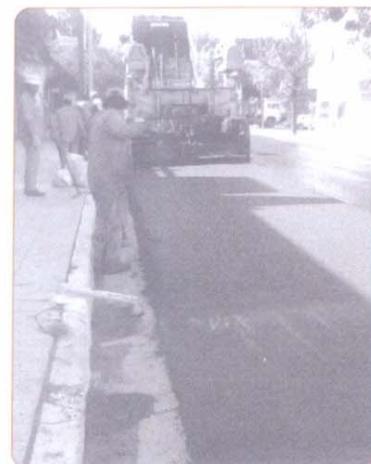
Extendido de la mezcla asfáltica en el pavimento urbano
